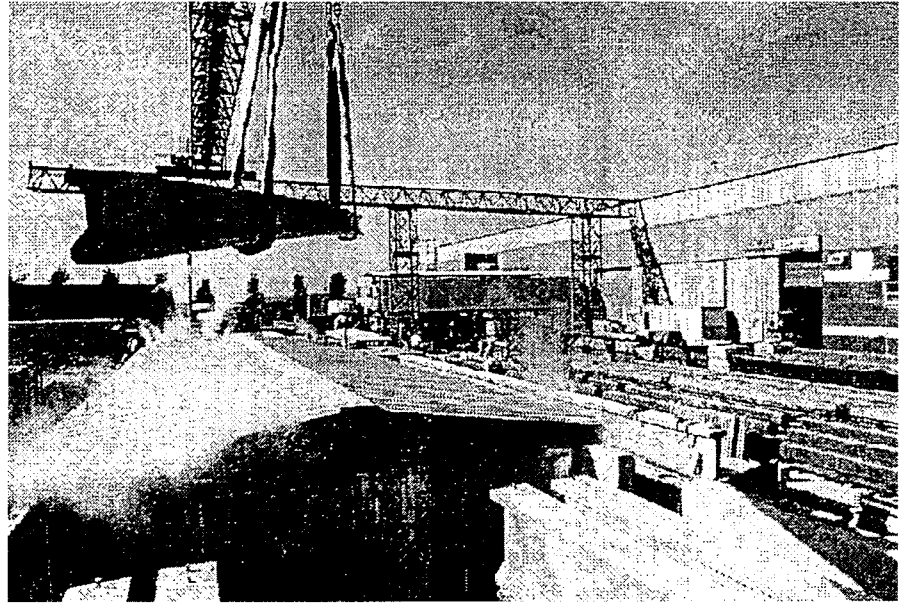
Prestressed concrete의 적용 예 (Cattenom 핵발전소용 prestressed beam)
